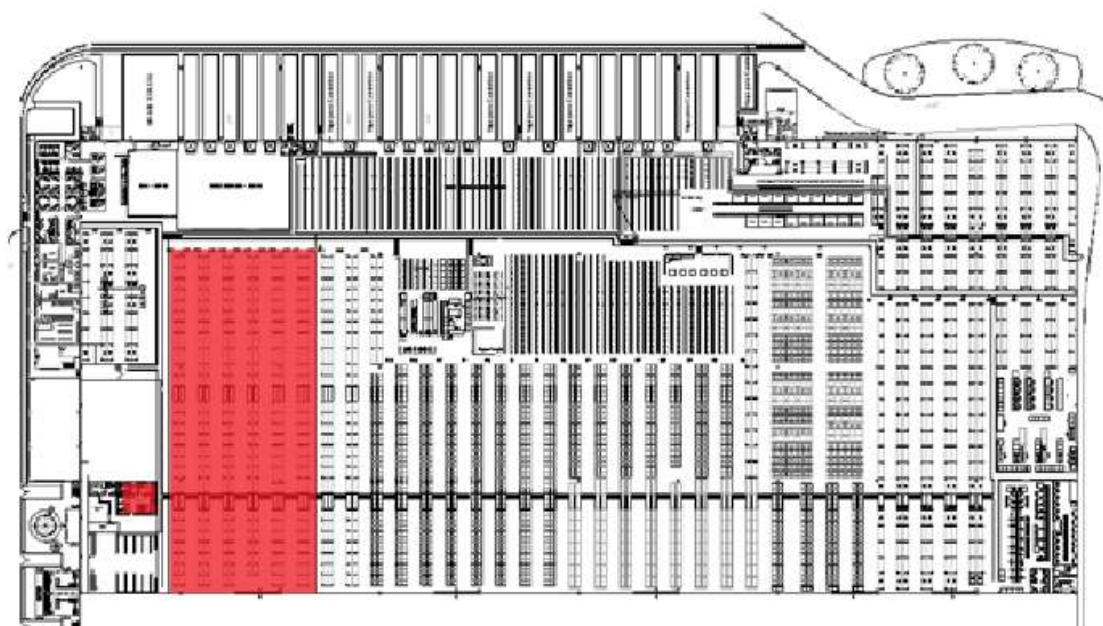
Planta Centro de Distribuição (Fonte: Autora)
